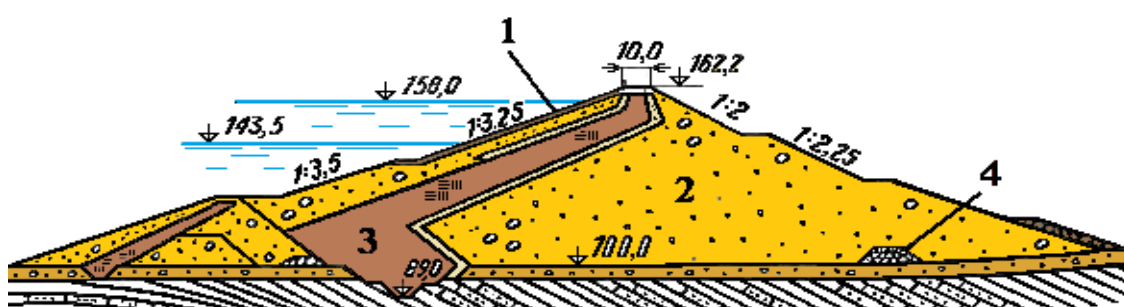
Поперечное сечение русловой и пойменной земляных неоднородных плотин Шамкирского гидроузла (длина 3,8 км, наибольшая высота 70 м, Азербайджан, 1975-1982гг.): 1 – железобетонное крепление плитами 8х8х0,3 м по гравийной подготовке толщиной 0,3 м; 2 – гравийно-галечный грунт; 3 – экран из суглинки; 4 – дренажная призма
